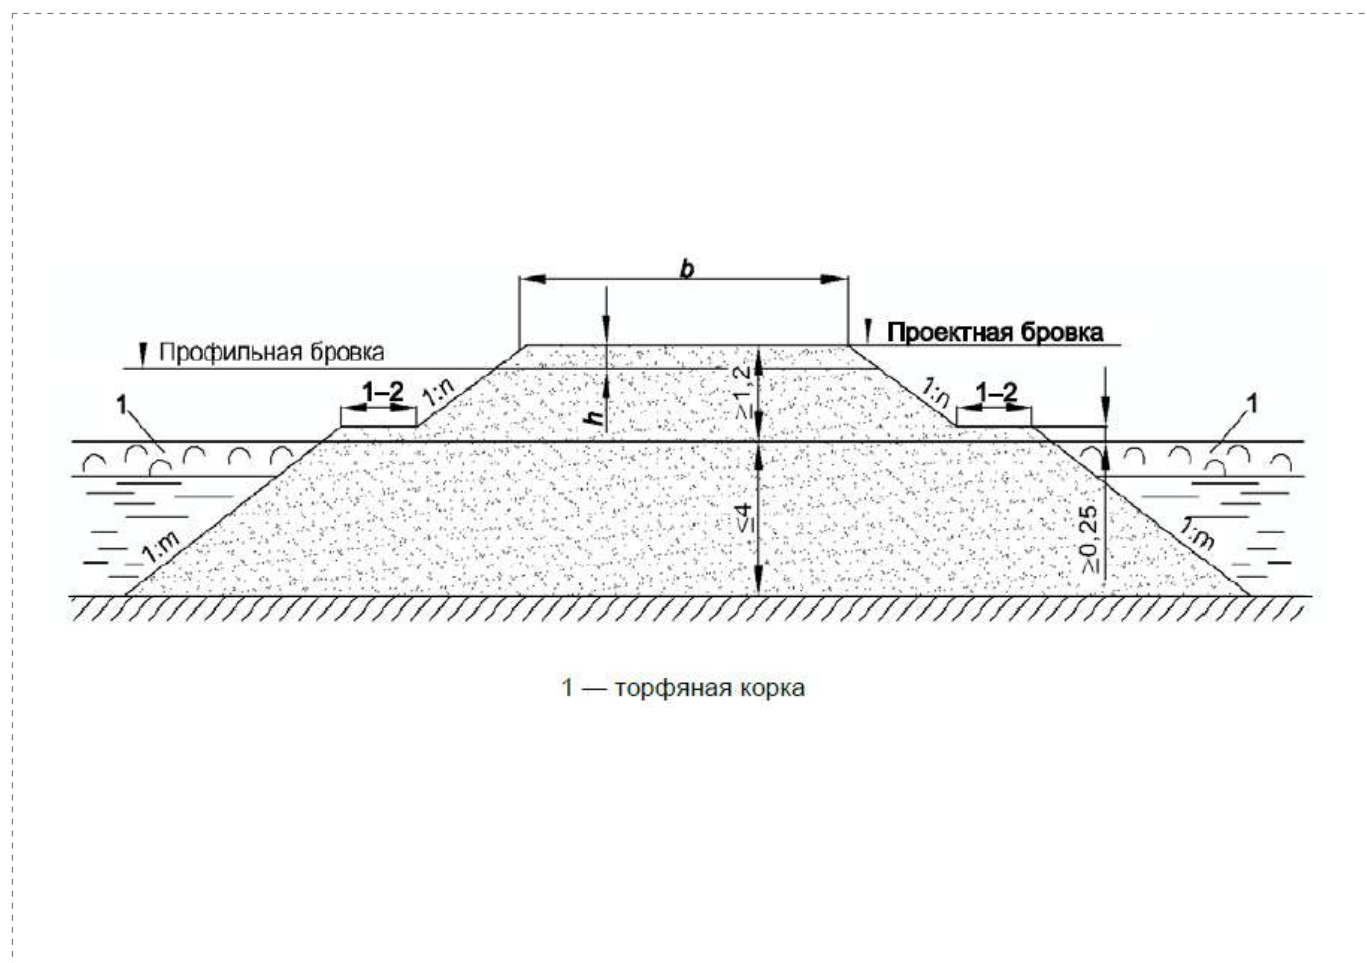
Поперечный профиль насыпи на болотах III типа глубиной до 4 м при поперечном уклоне основания не круче 1:20
